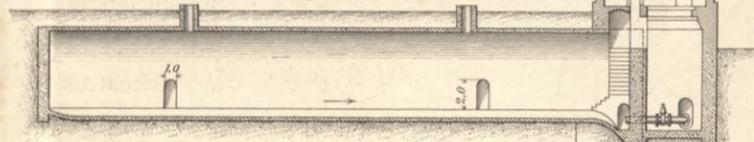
<sup>b</sup> Grundriss. M. 1:500.
